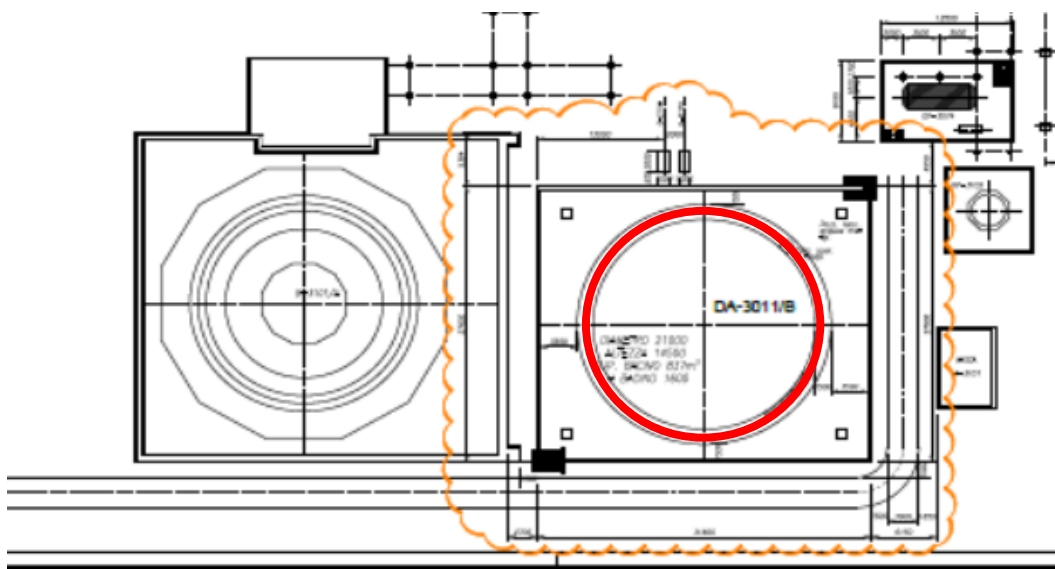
Stralcio planimetrico del serbatoio DA-3011/B in zona 50 sud Impianto Etilene
